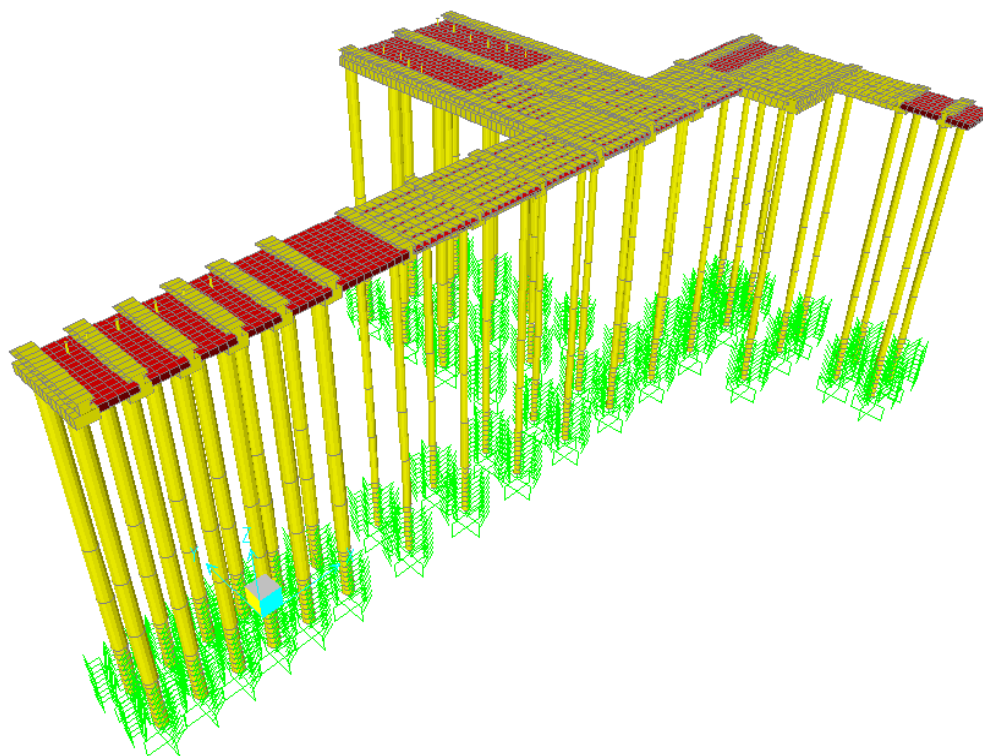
Vista Isométrica do Modelo Estrutural – Projeto Executado (PE)
